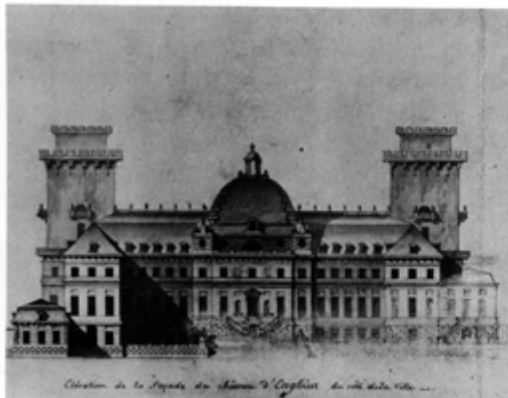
Charles DE WAILLY, Elévation de la façade
